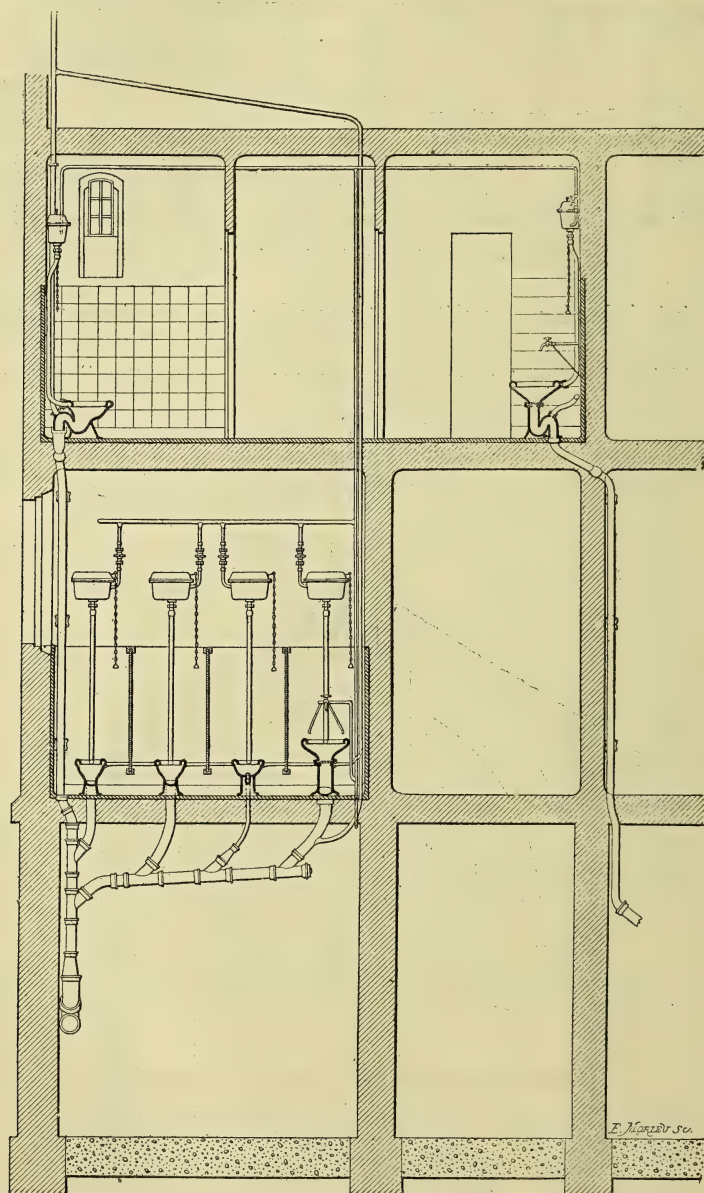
Installations sanitaires d'un pavillon de malades à l'hôpital Boucicaut.
